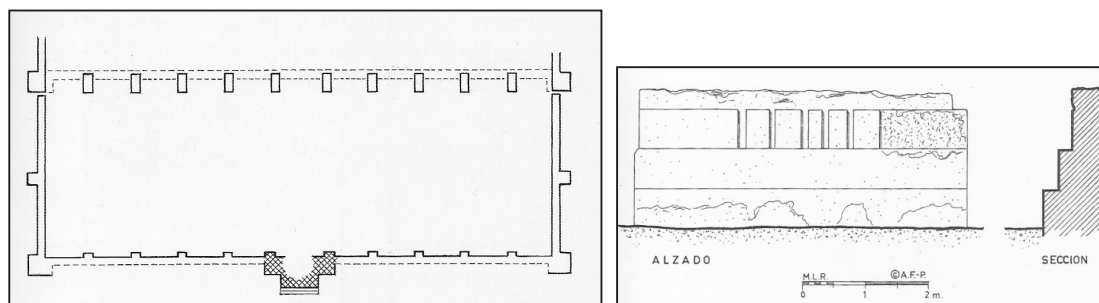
y 6. Planta y alzado según M. López Reche y A. Fernández-Puertas.
